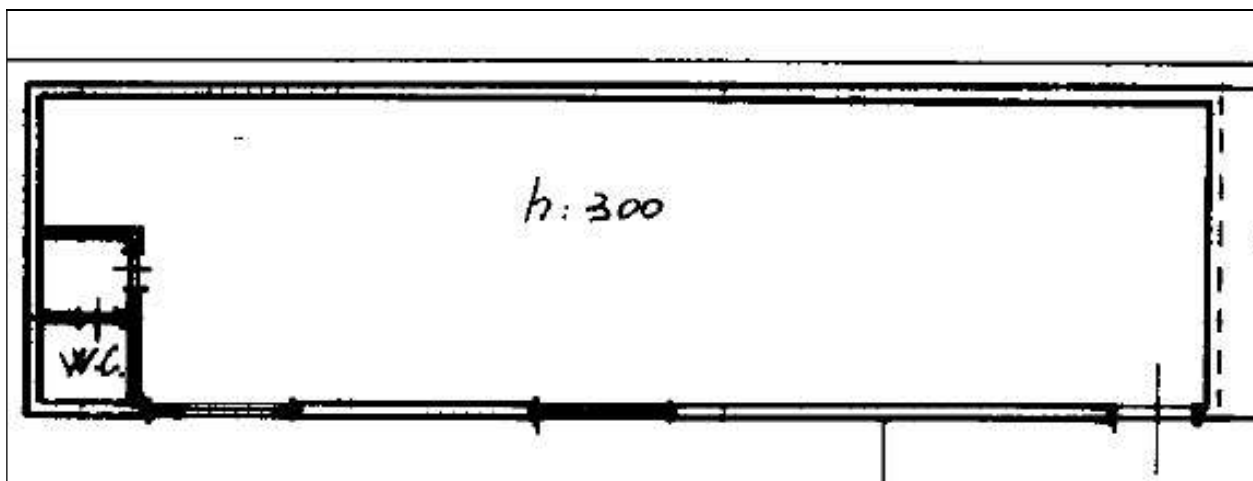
Estratto elaborato planimetrico – Sez. SNA fg.6 Part. 4333 sub 16
